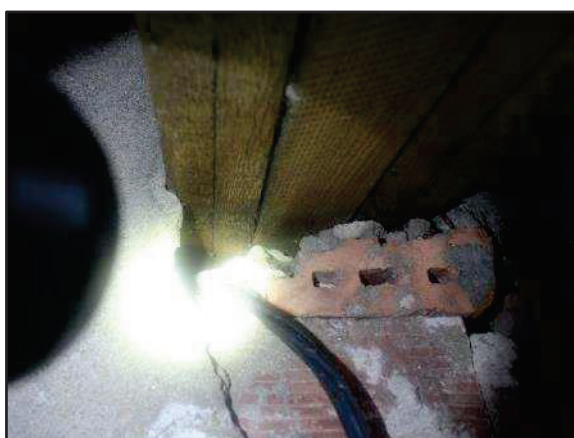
hohlraumbietender Mauerausbruch (potentielles Fledermausquartier) an Außenwand unterhalb Dachauflage nahe Nordwestecke des Gebäudes 3 (Stall)
